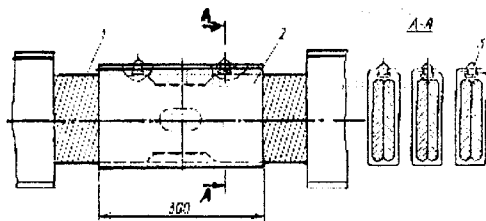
Ізолювання зварних ділянок шин ШМА4 на 1250 та 1600 А:
